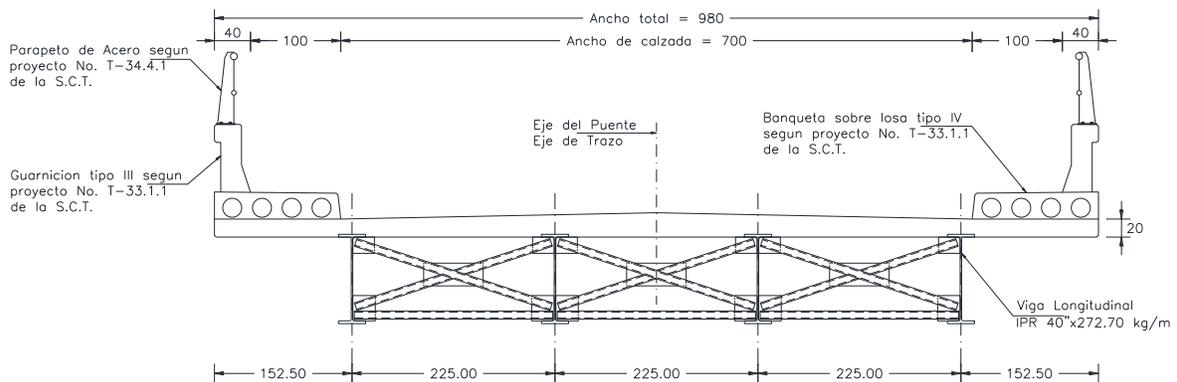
Sección transversal de contraenteo en vigas IPR 40"x272.70 kg/m (diafragma).
